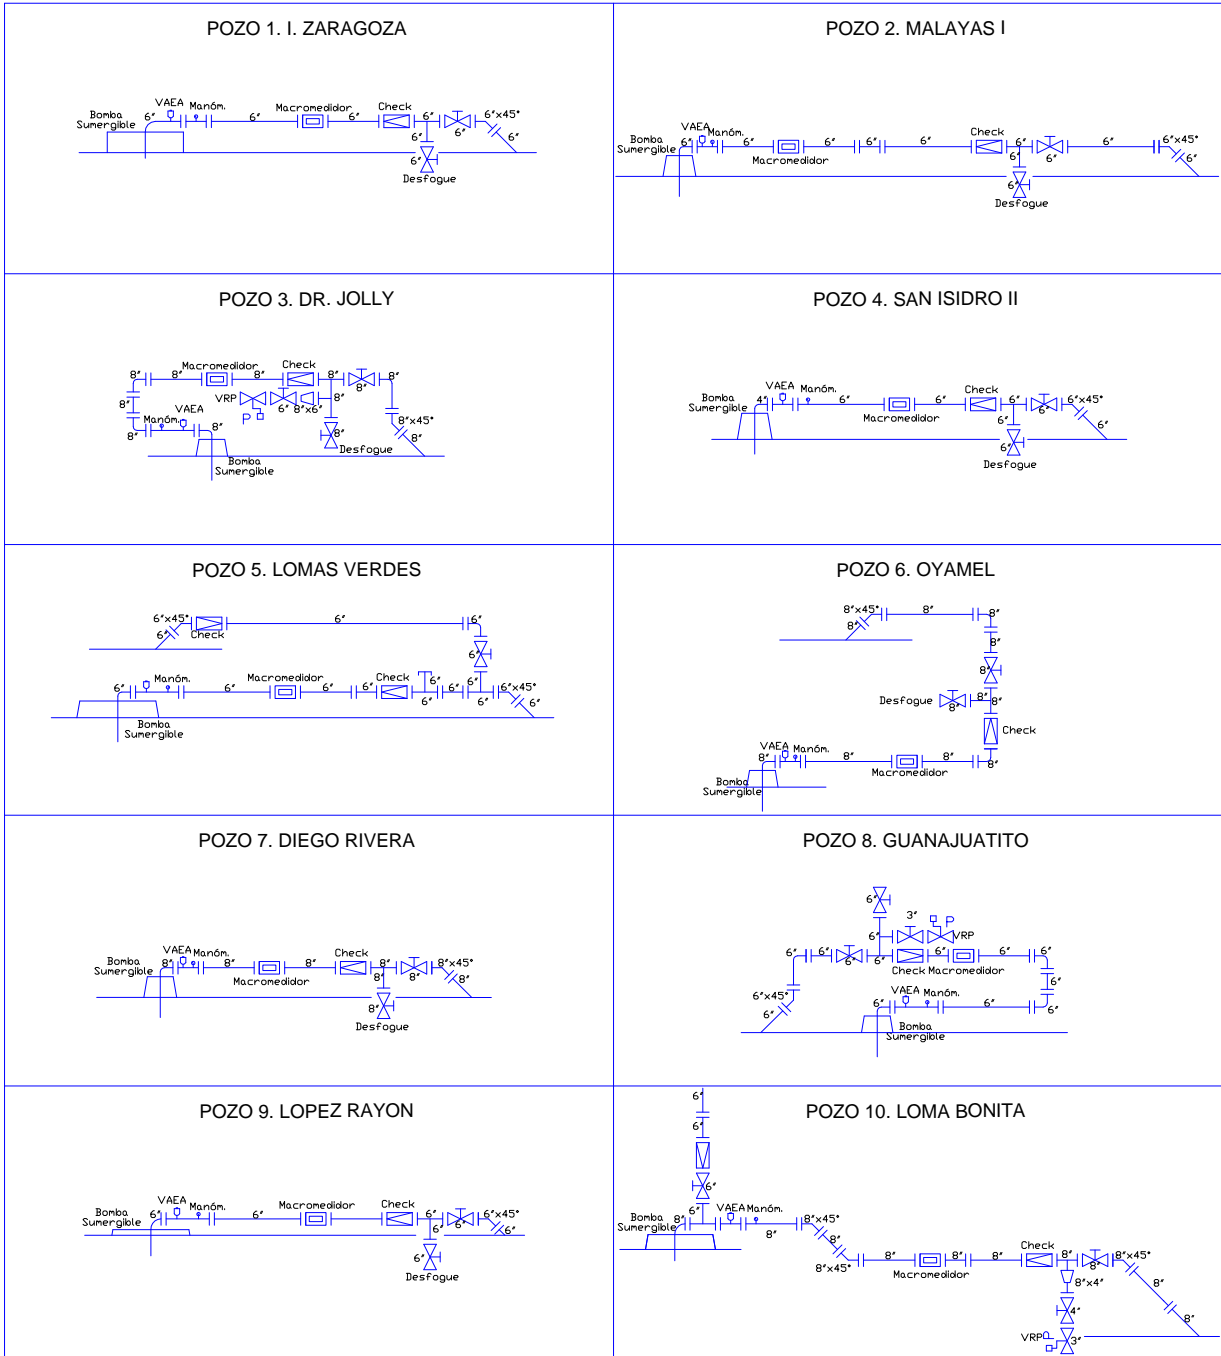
Detalles de fontanería de las captaciones en Acámbaro
